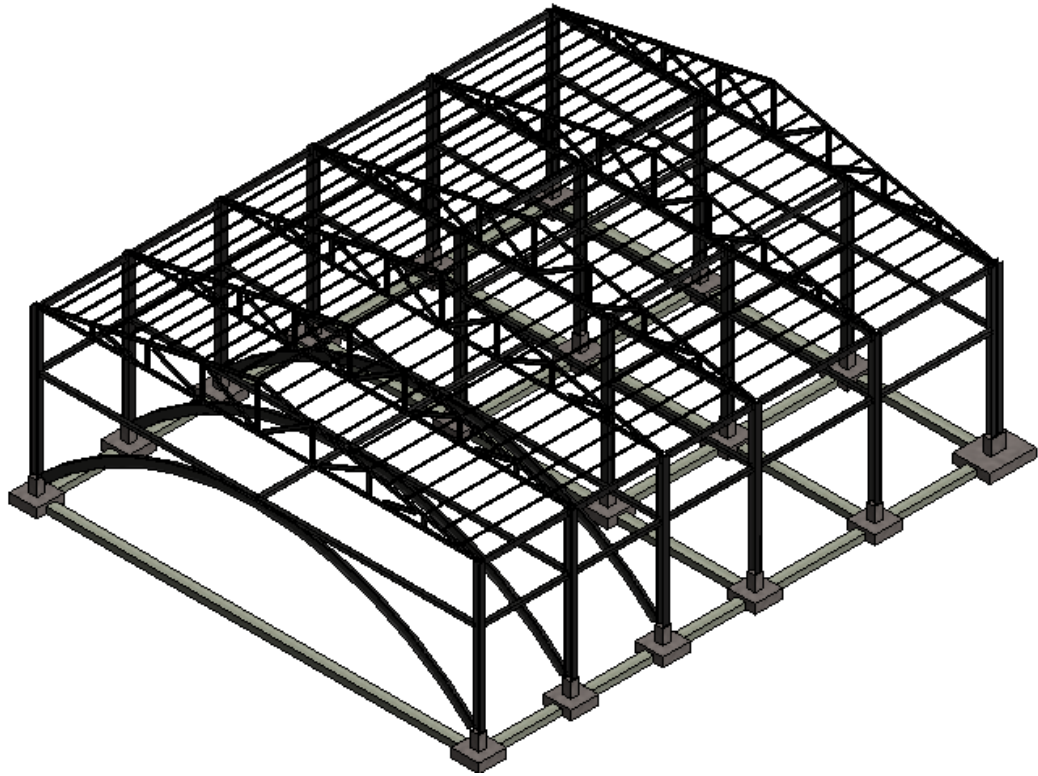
Estructura final de la cubierta para la zona de las oficinas.
